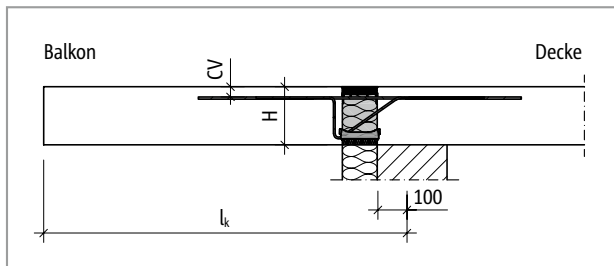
Schöck Isokorb® XT Typ K-M1 bis M10: Statisches System
